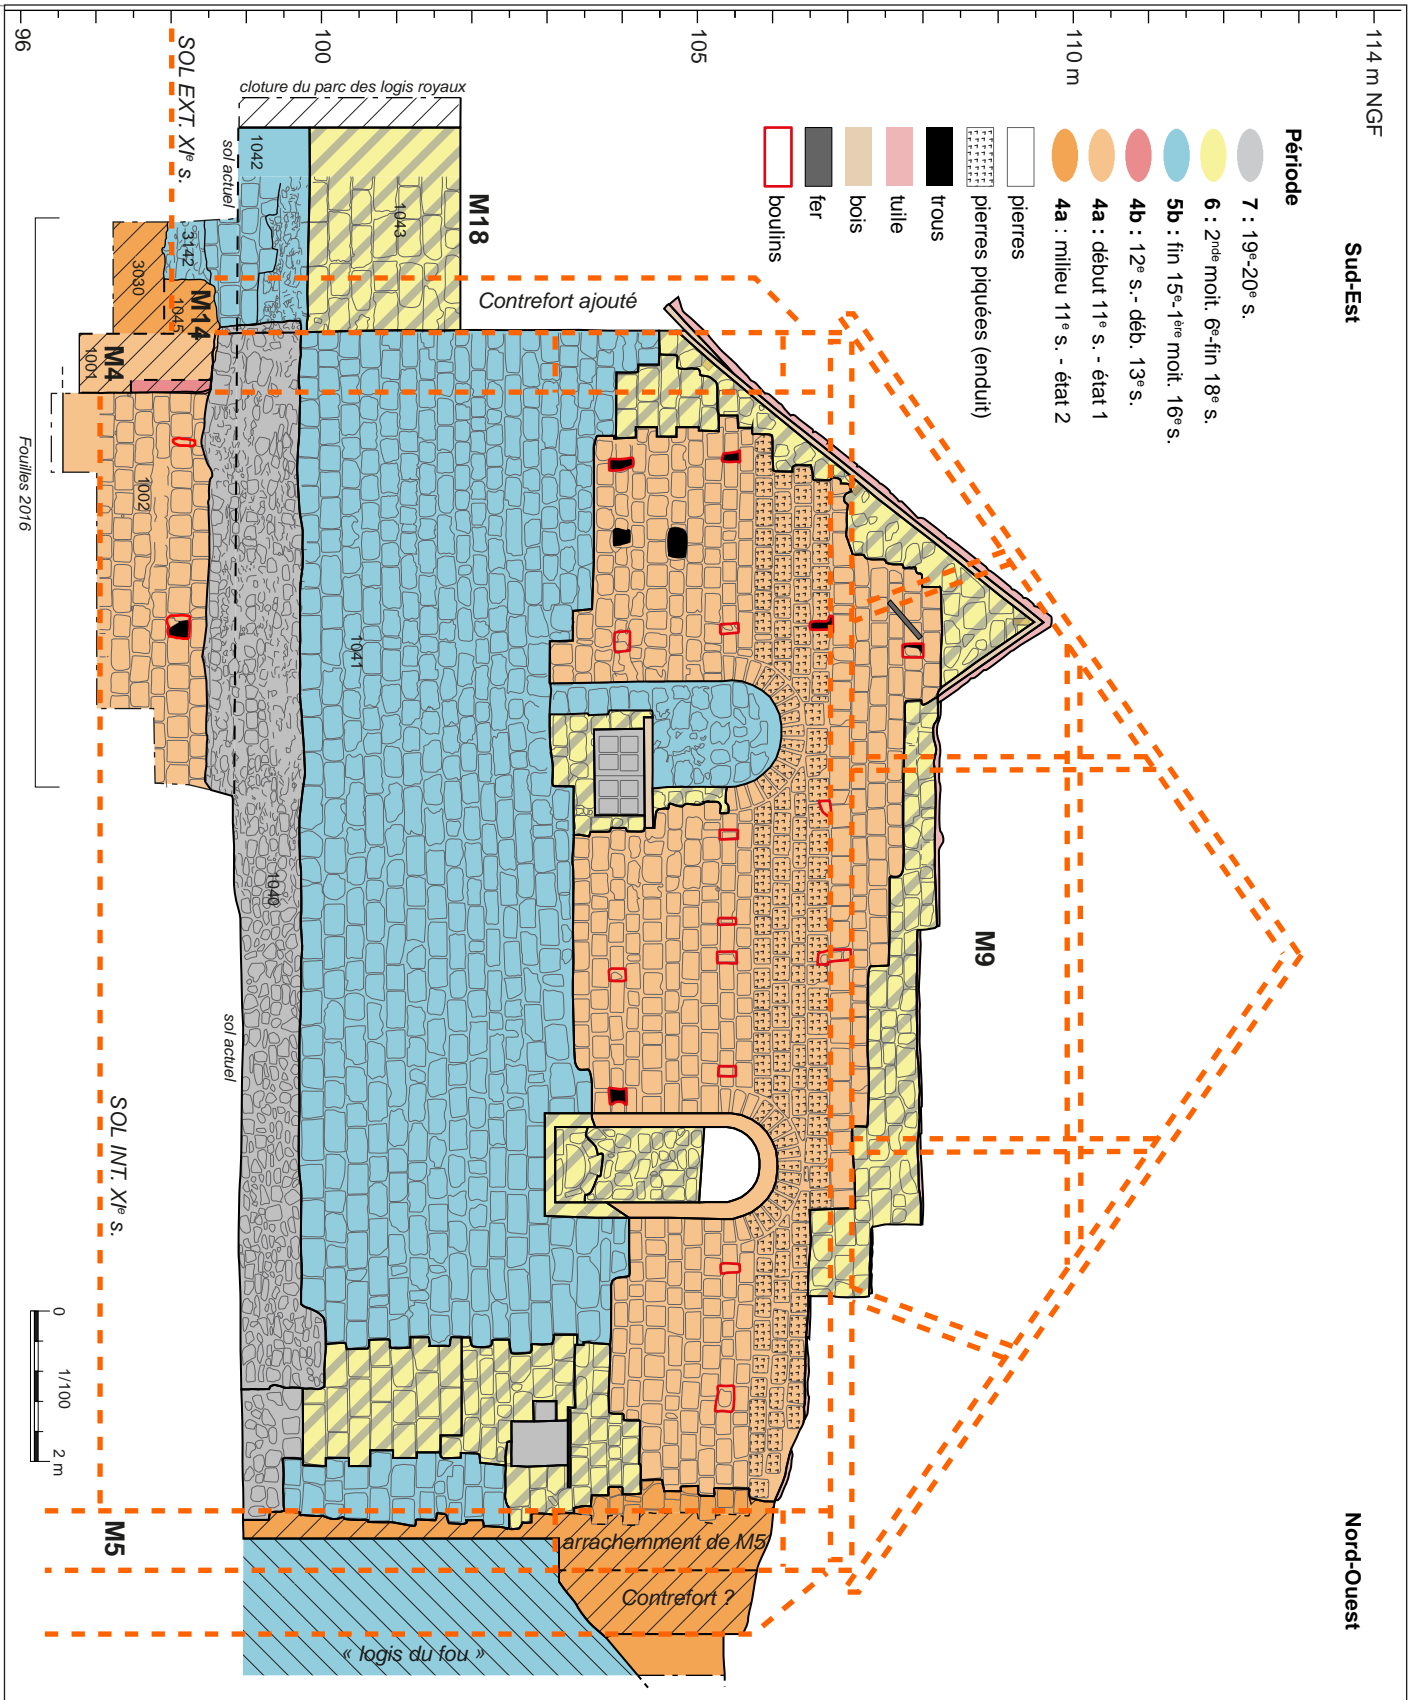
Relevé pierre à pierre du mur M9, avec la restitution de l'élevation du bâtiment de la grande salle du 11^e s.
